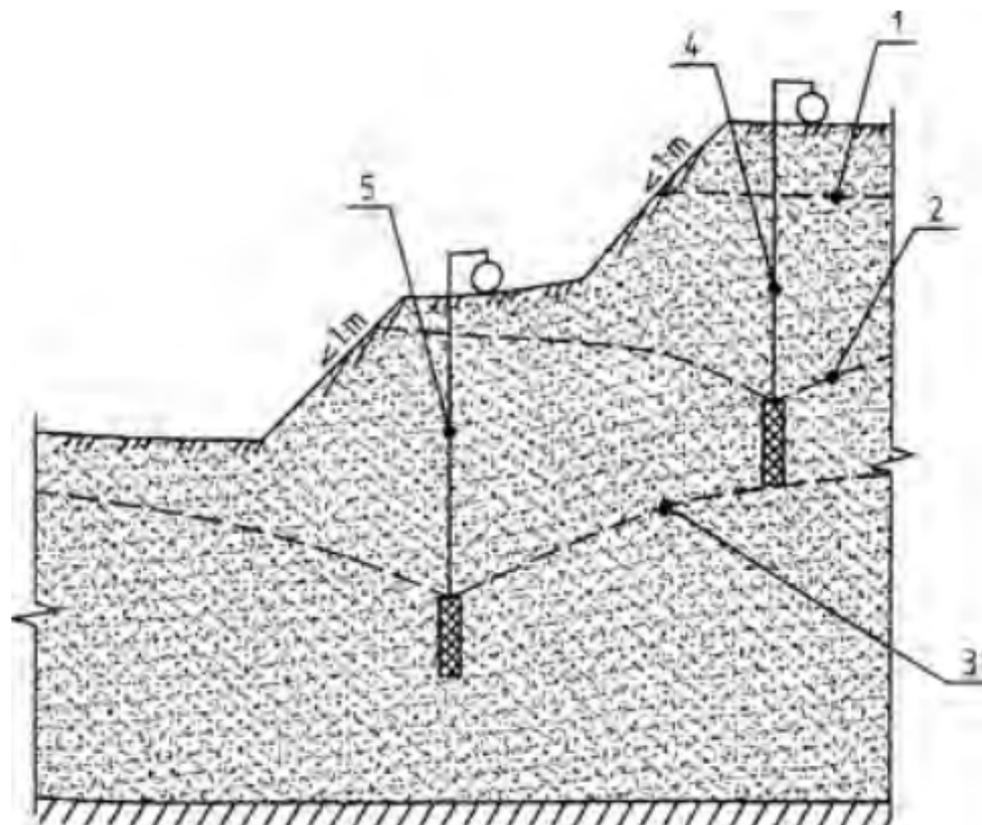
Схема грунтового понижения двухъярусными ЛИУ:
